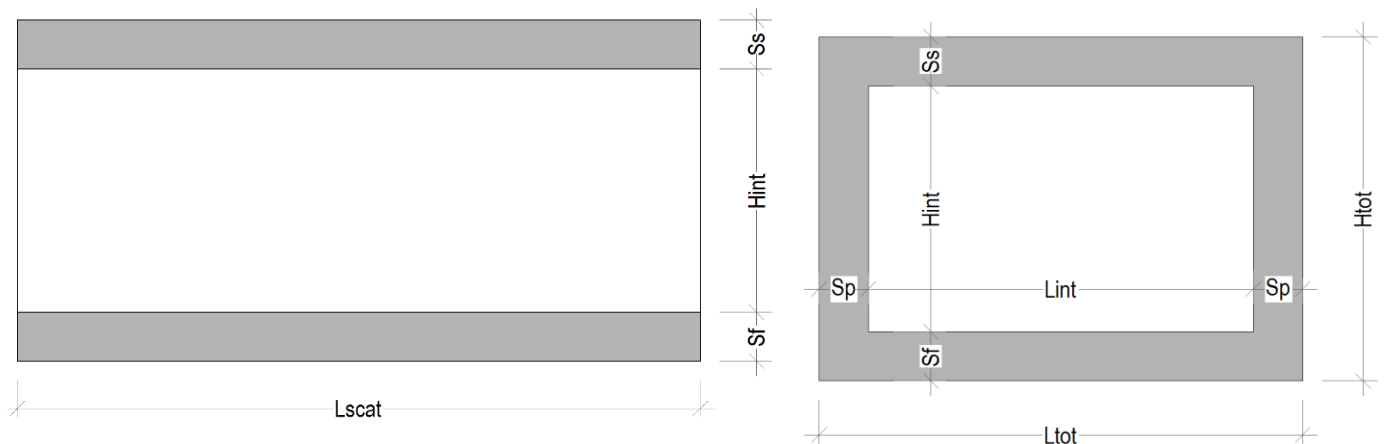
Planimetria dell'opera – Sottovia SL04
